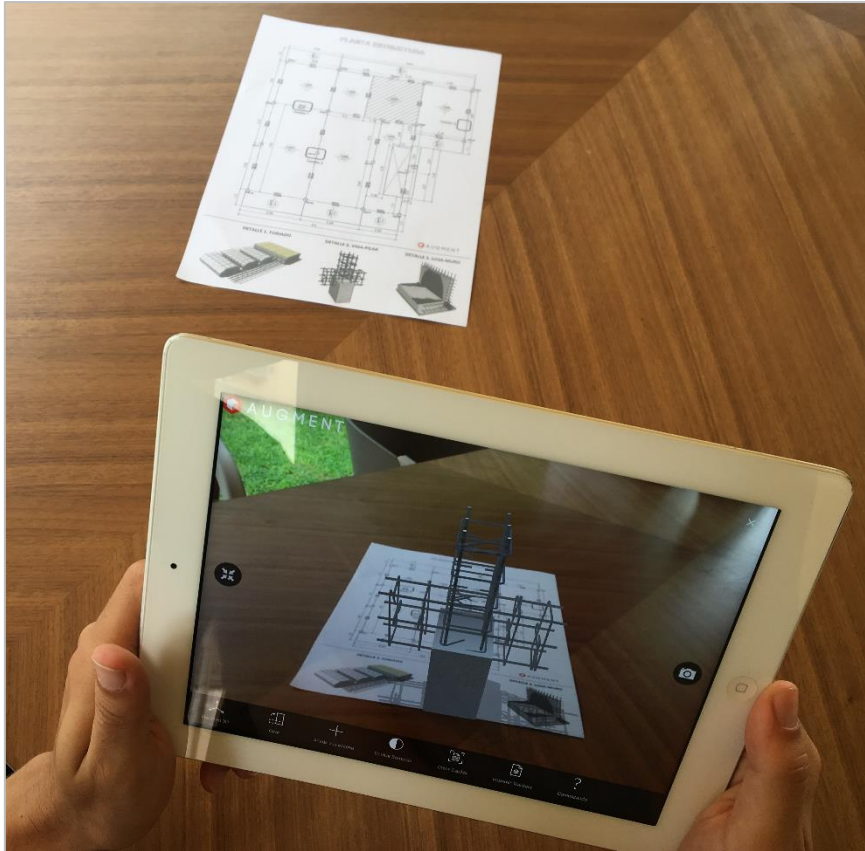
Visualización en RA de detalle constructivo sobre plano.
